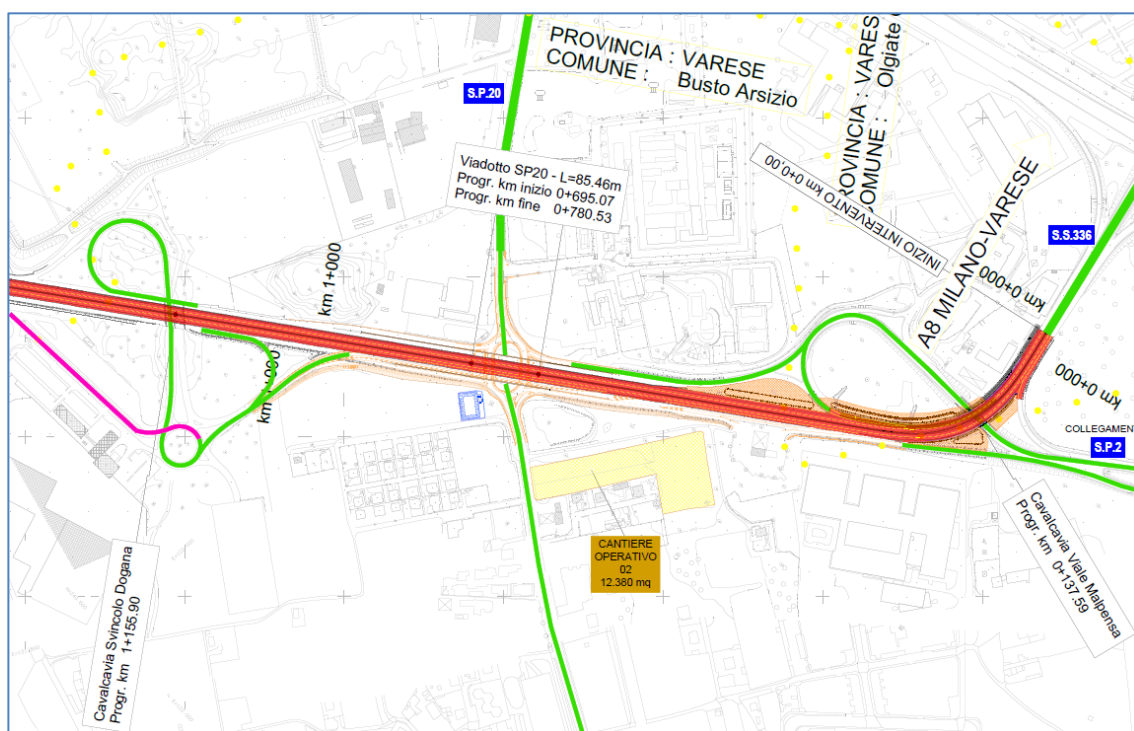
Stralcio elaborato T00CA00CANPU02B Planimetria aree di cantiere e viabilità di servizio
